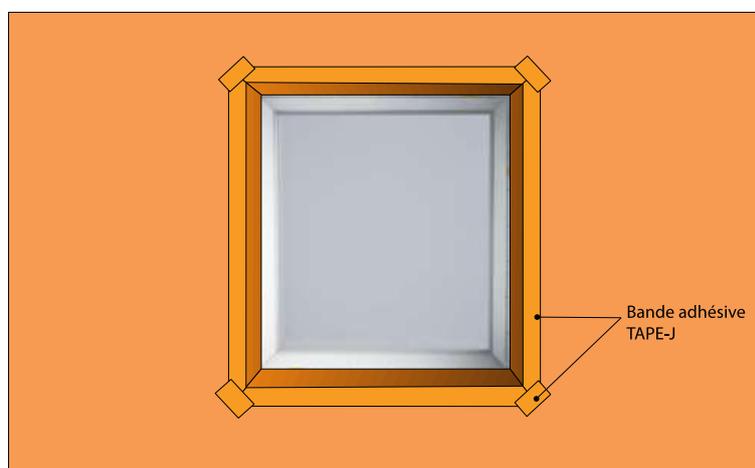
Étanchéité à l'air autour d'une fenêtre de toit plat
